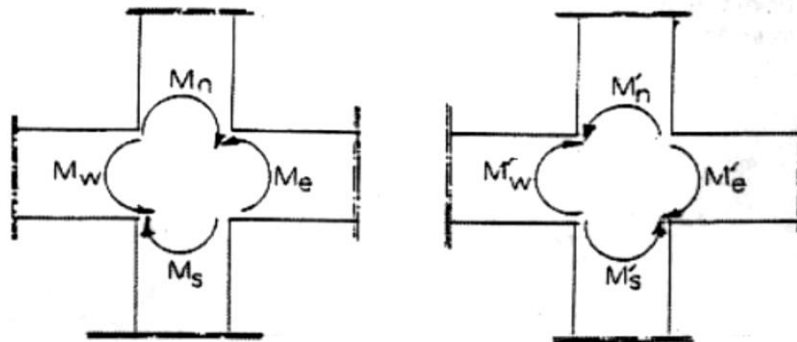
Dimensionnement d'un noeud poutre-poteau [24]
